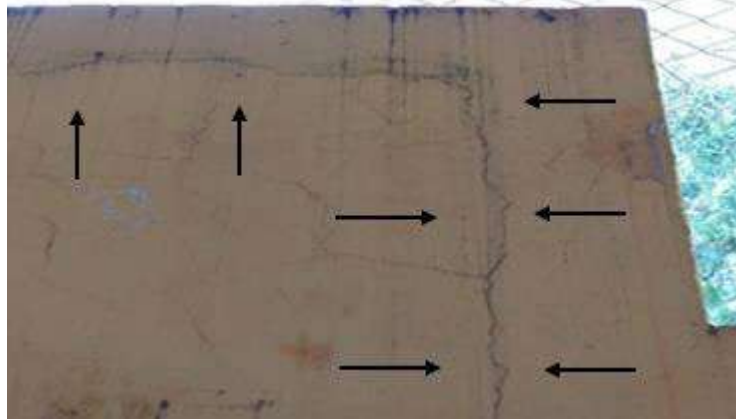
Trincas verticais e horizontais: emenda na parede de alvenaria.
